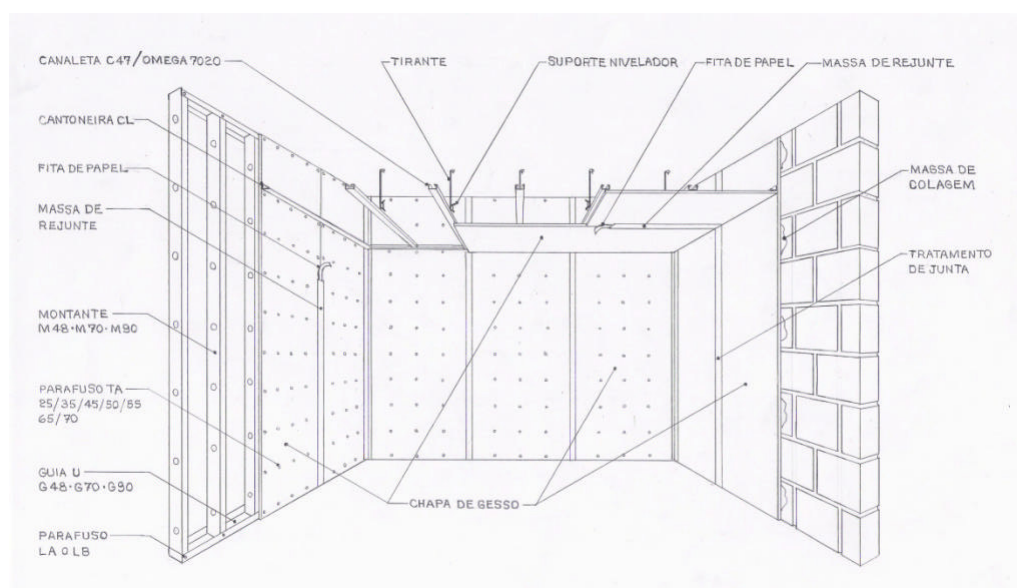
Ilustração do sistema em drywall com chapas de gesso
